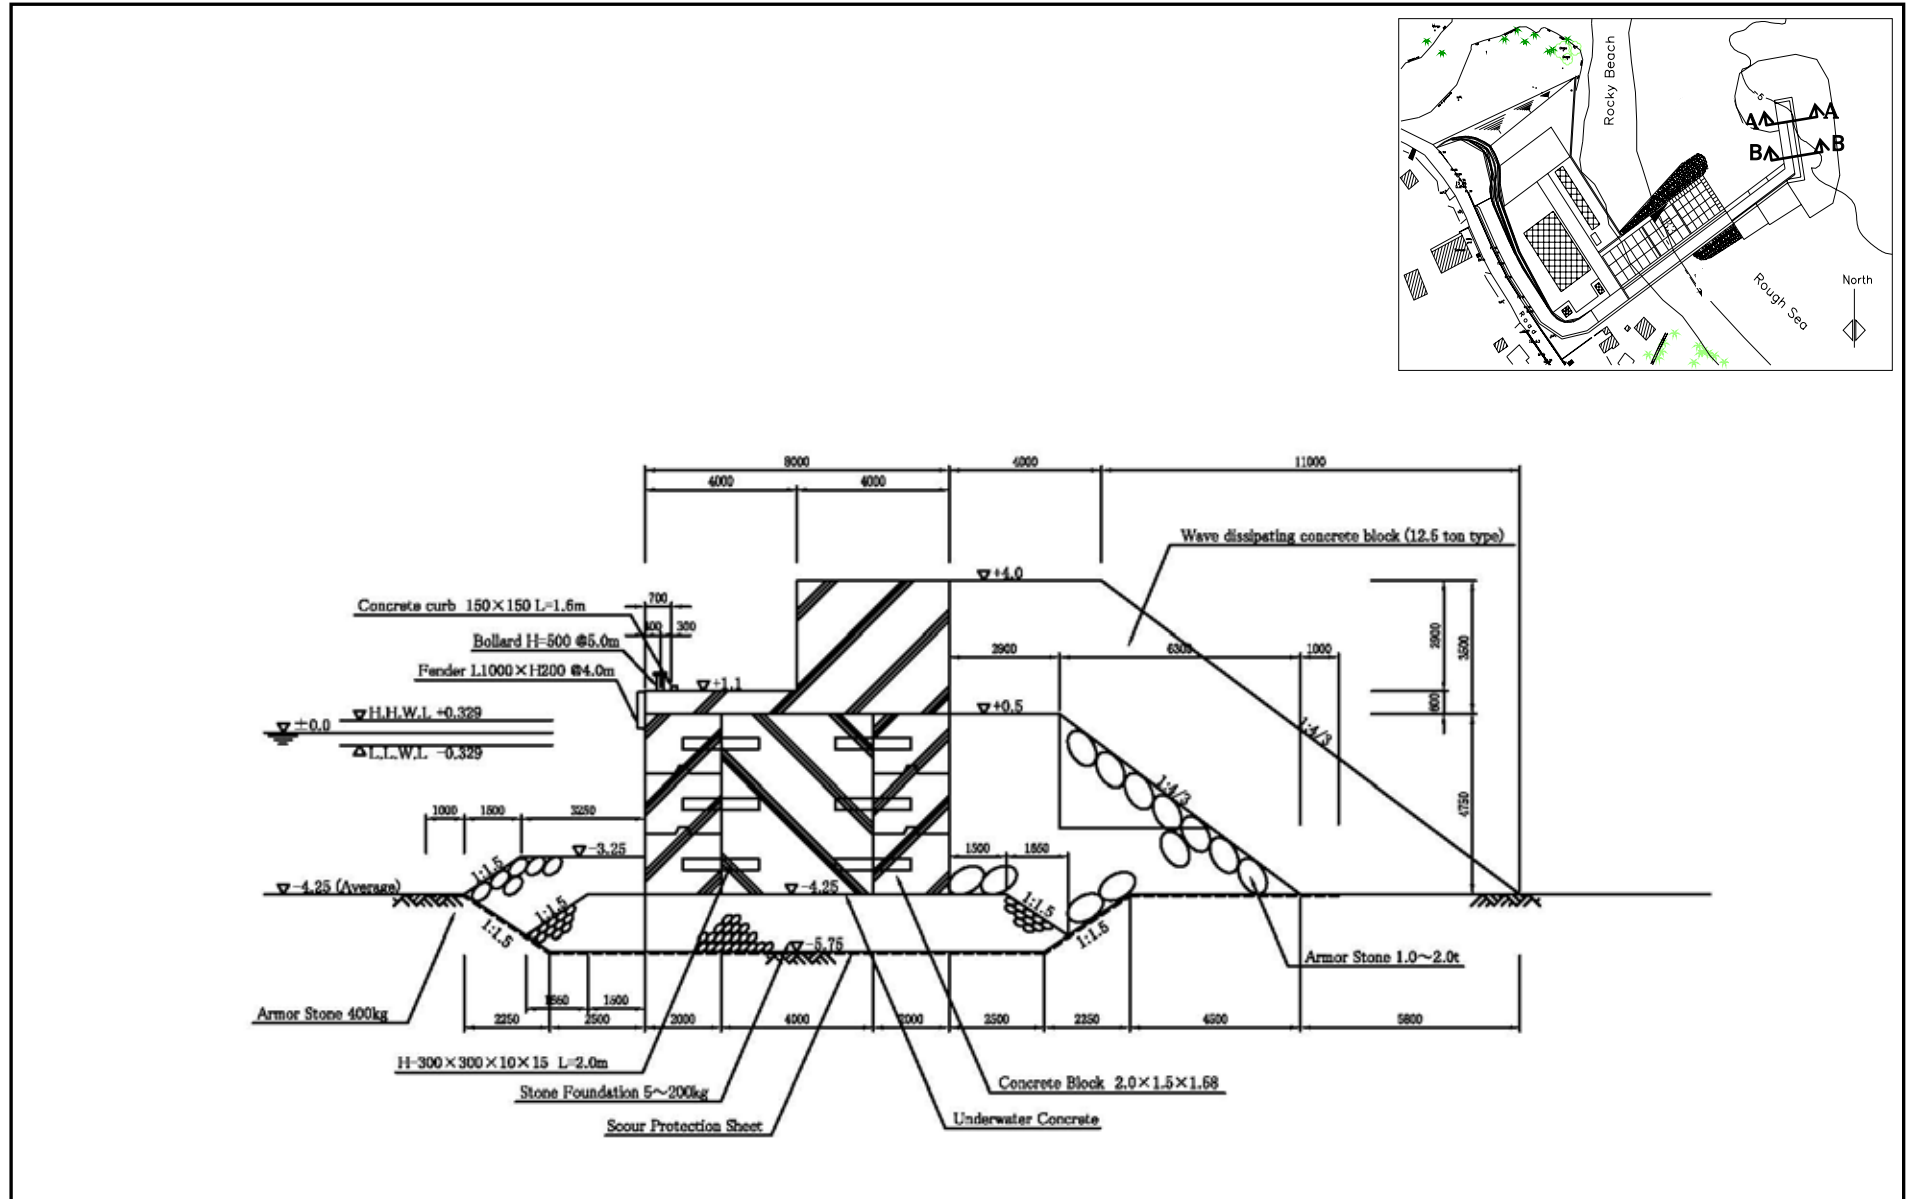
(3) 防波堤断面图 (B - B 断面)
